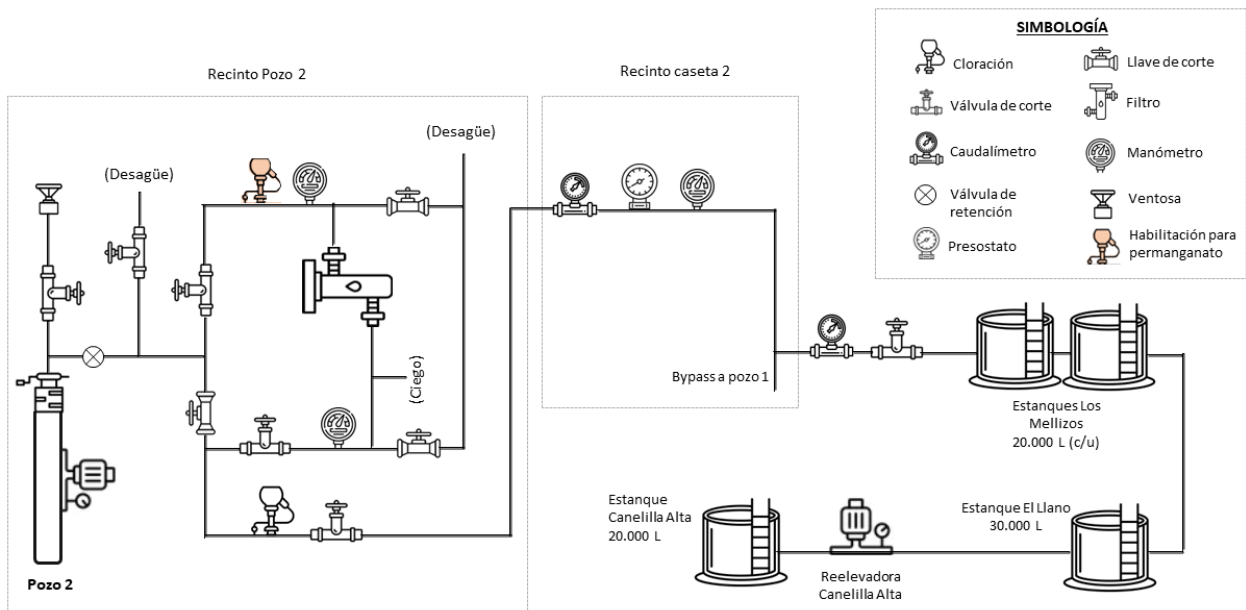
Layout sistema pozo 2 APR Villaseca. Elaboración propia.
